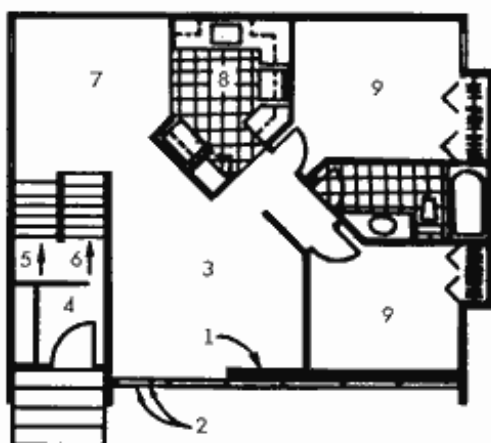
План энергоэффективного дома фирмы ConceptConstruction.
